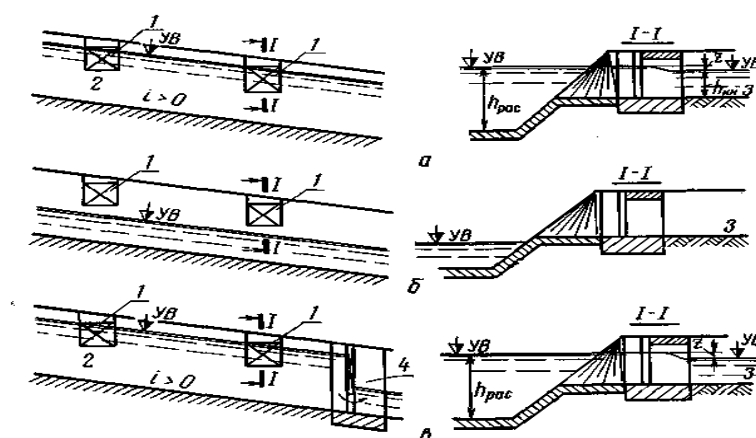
Режим работы канала при устройстве перегораживающего сооружения: а – нормальная работа канала без перегораживающего сооружения; б – пропуск по каналу пониженных (минимальных) расходов воды; в – подпор уровня перегораживающим сооружением; 1 – водовыпуск на канале; 2 – канал с размещенными на нем водовыпусками; 3 – канал младшего порядка; 4 – перегораживающее сооружение
